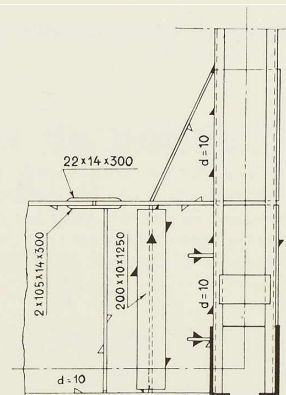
Assemblage d'une entretoise avec une poutre principale.
